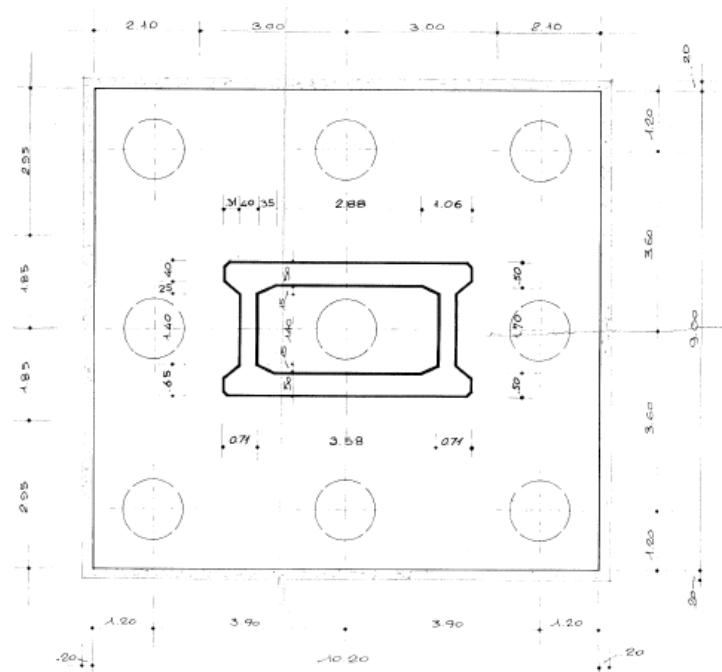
Pianta della fondazione con indicazione dei pali, 9 pali
